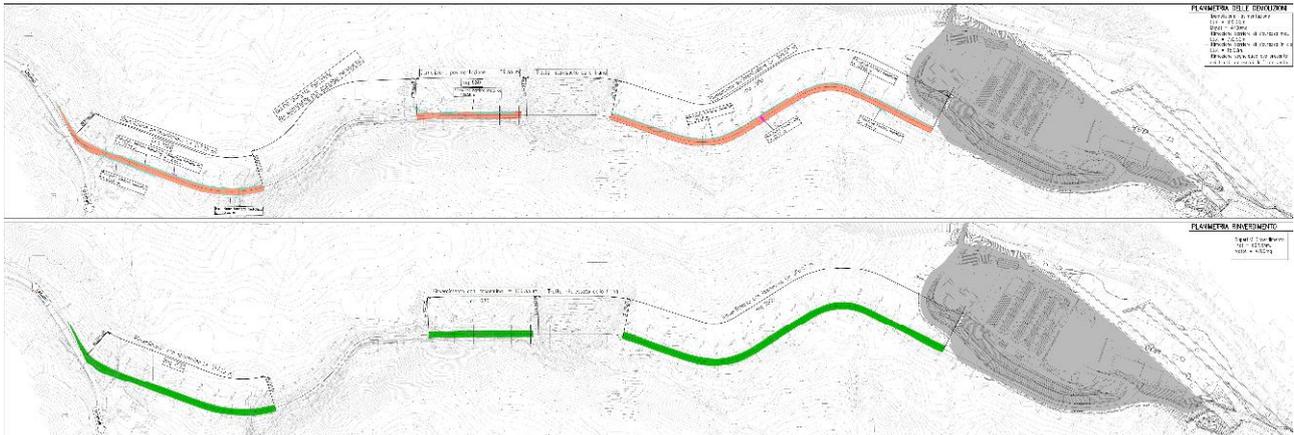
Stralcio planimetrico demolizione e rinverimento VS6 Pista
